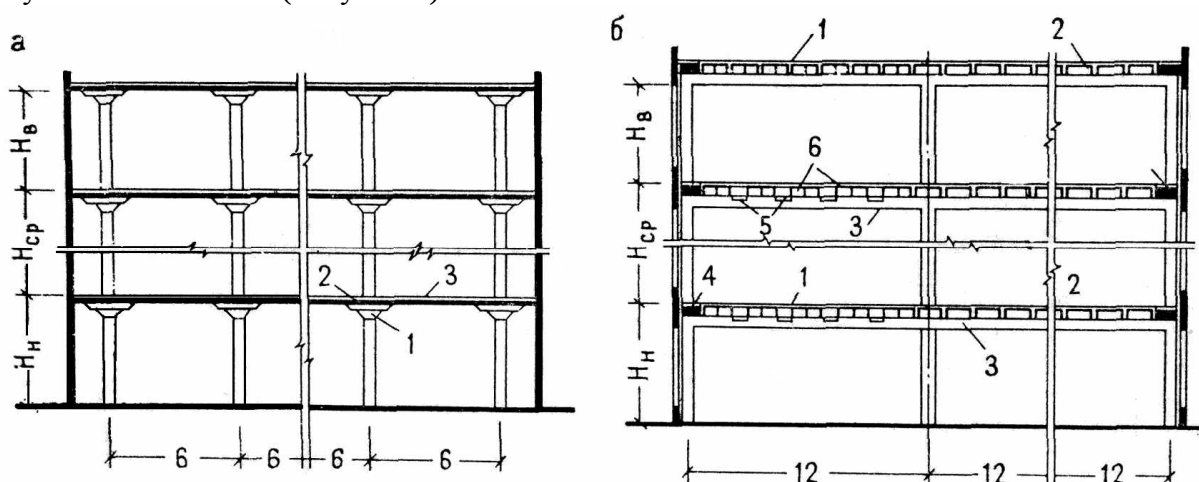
Конструктивные схемы многоэтажных каркасных промышленных зданий:
